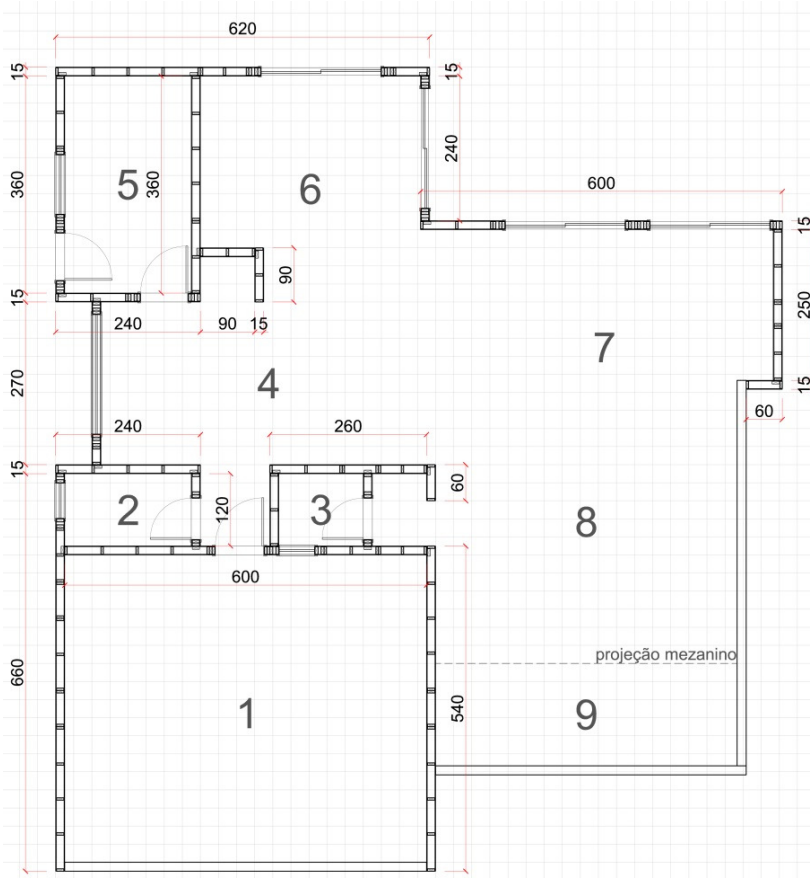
Planta do pavimento superior com a proposta de painéis verticais modulares. Dimensões em cm, sem escala.
